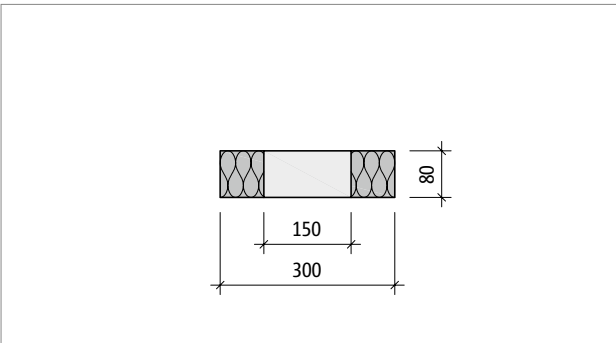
Schöck Sconnex® Typ W-N: Produktschnitt
